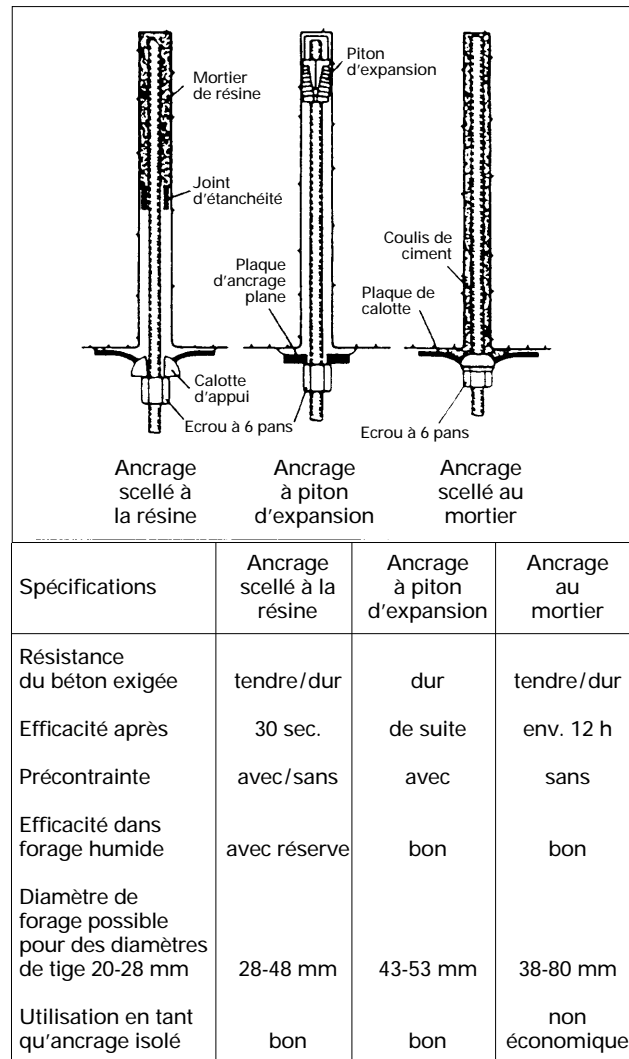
Report de forces de traction sur le béton existant au moyen d'ancrages (Jungwirth et al. 1986).
